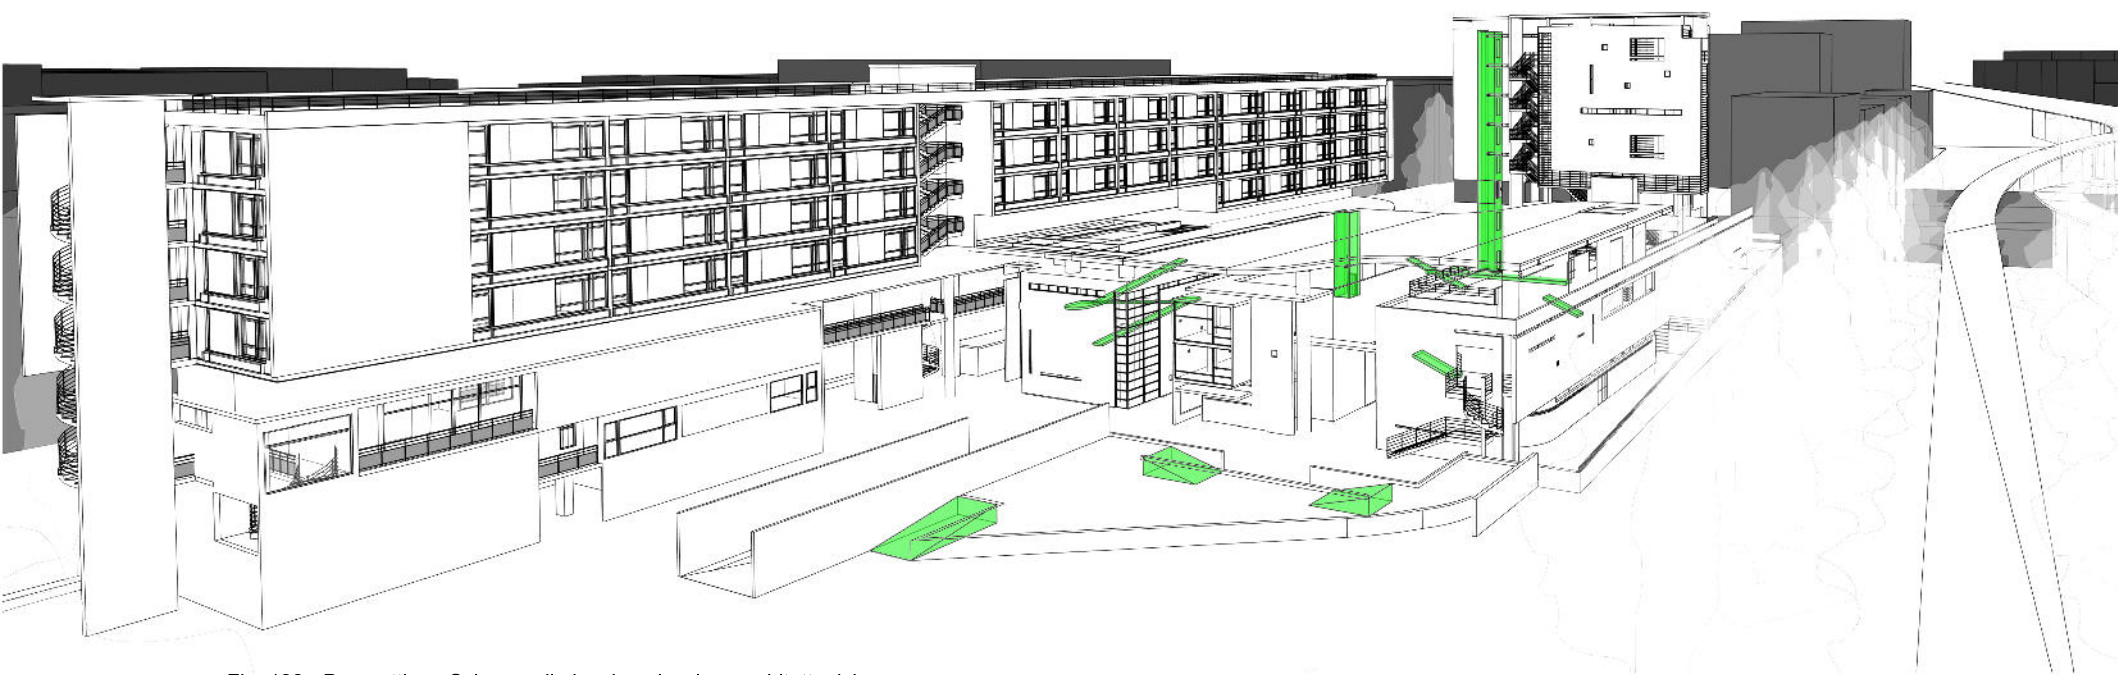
Prospettiva - Schema eliminazione barriere architettoniche
